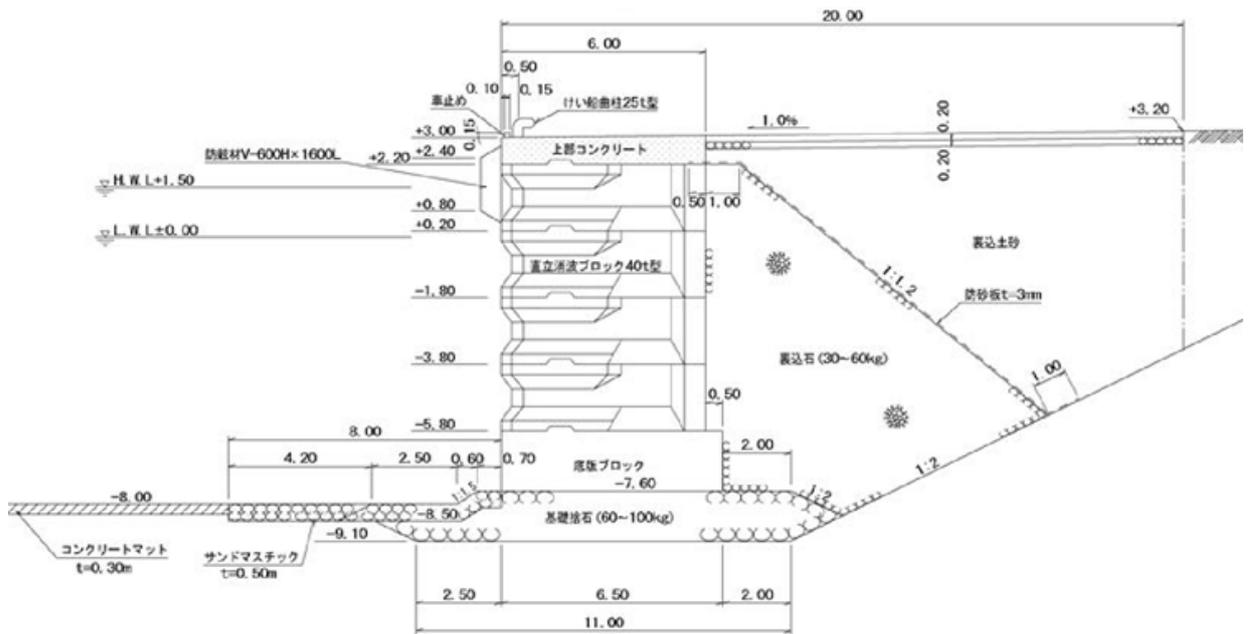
No.34 大洗港区_第3埠頭地区西岸壁 (-8m) の断面図 (被災前)
